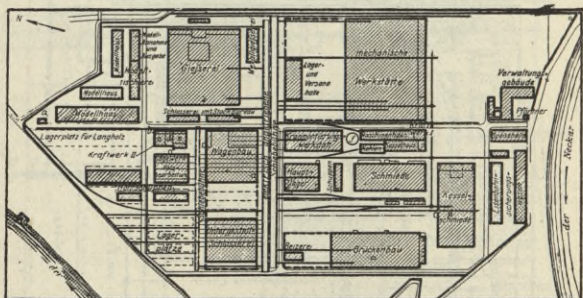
Maschinenfabrik Eßlingen. Werkplan.
